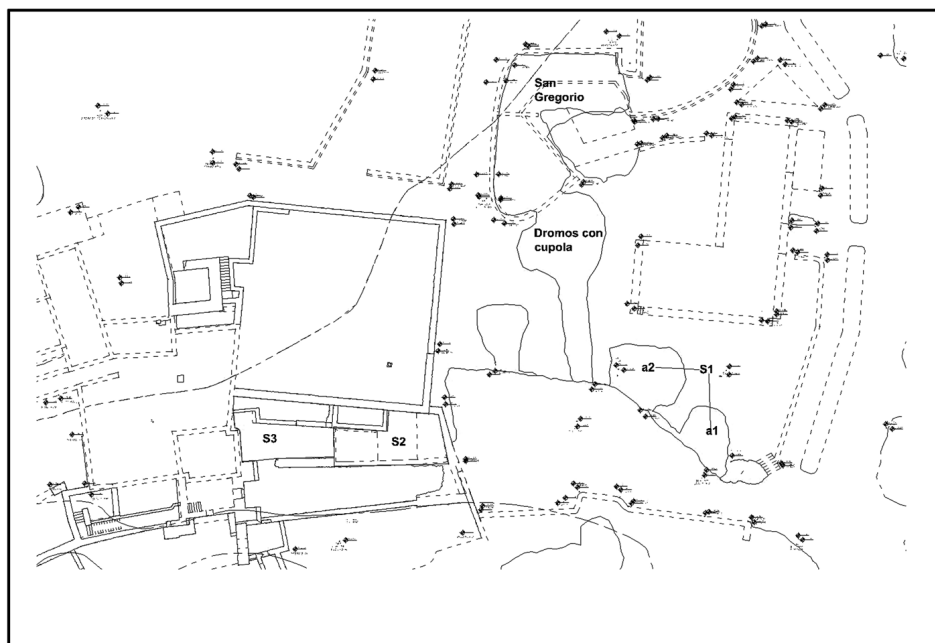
Planimetria generale delle cavità ipogee e dei corpi di fabbrica sovrastanti (Archivio SAR Puglia, elaborazione degli autori).
